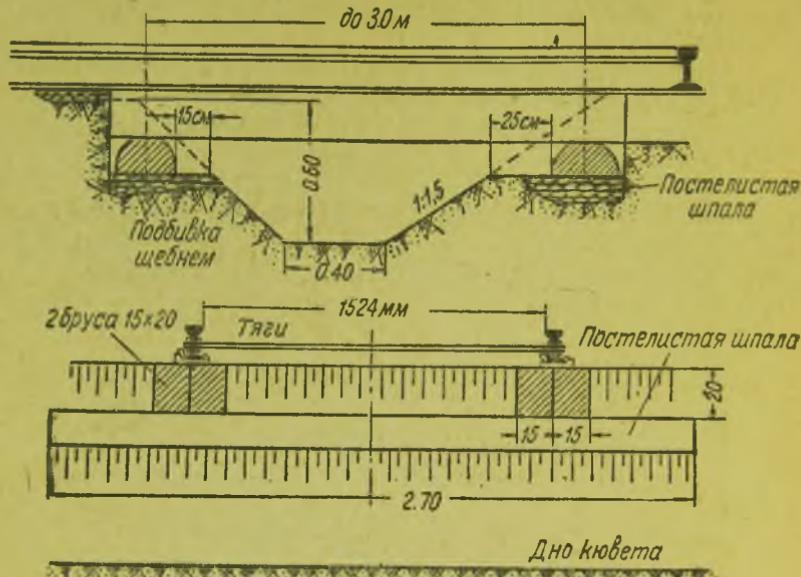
Перекрытие кювета при пролете до 1 м.
